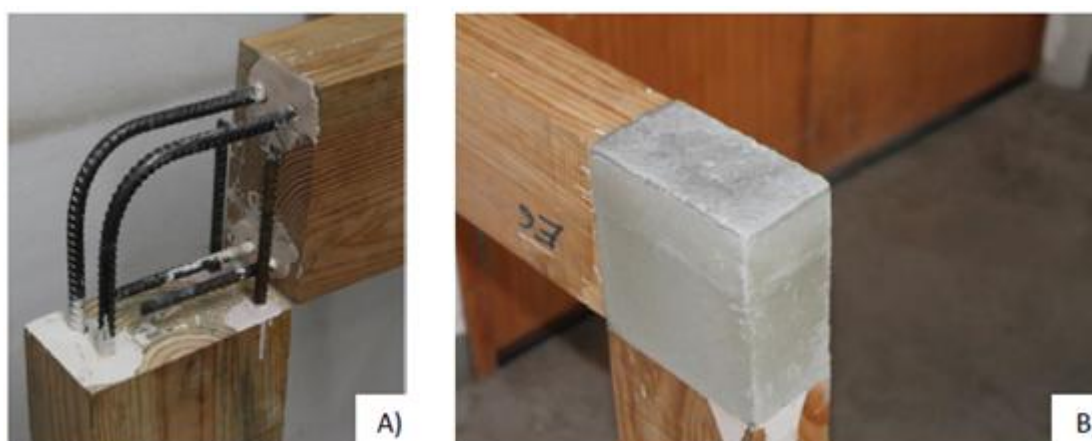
Detalhe do nó de ligação: A) Disposição das armaduras; B) Ligação pronta a ensaiar. (Gonçalves, 2014)
